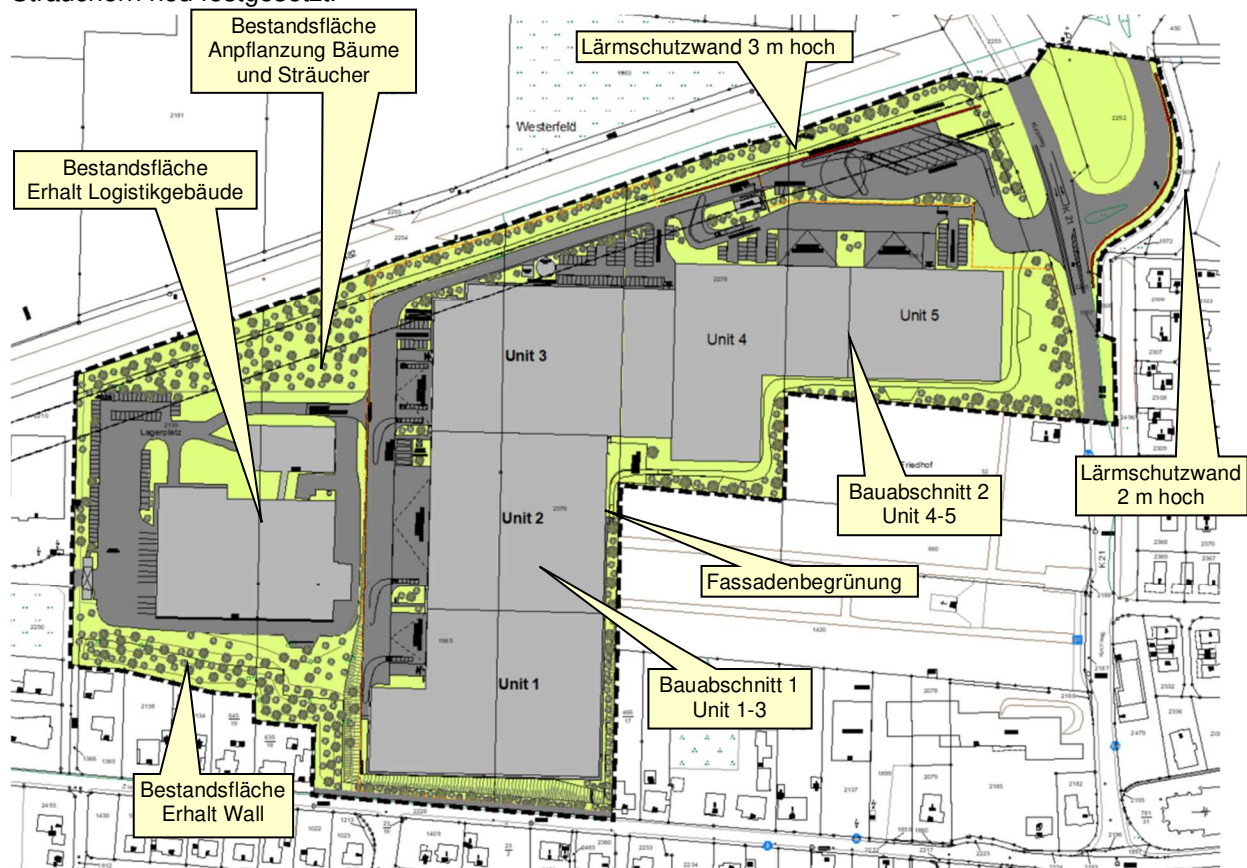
Lageplan Bestand und Vorhaben (ohne Maßstab)
